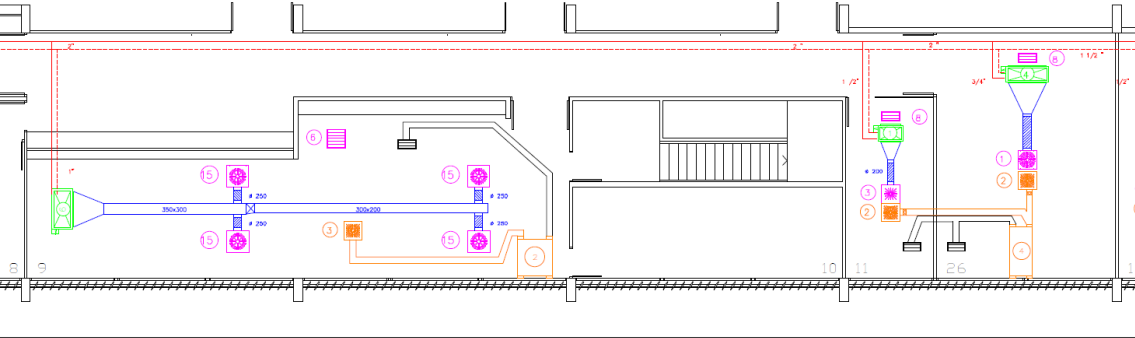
Vista de equipos de ventilación descentralizados en las salas de la planta baja. Fuente: Elab. propia.
